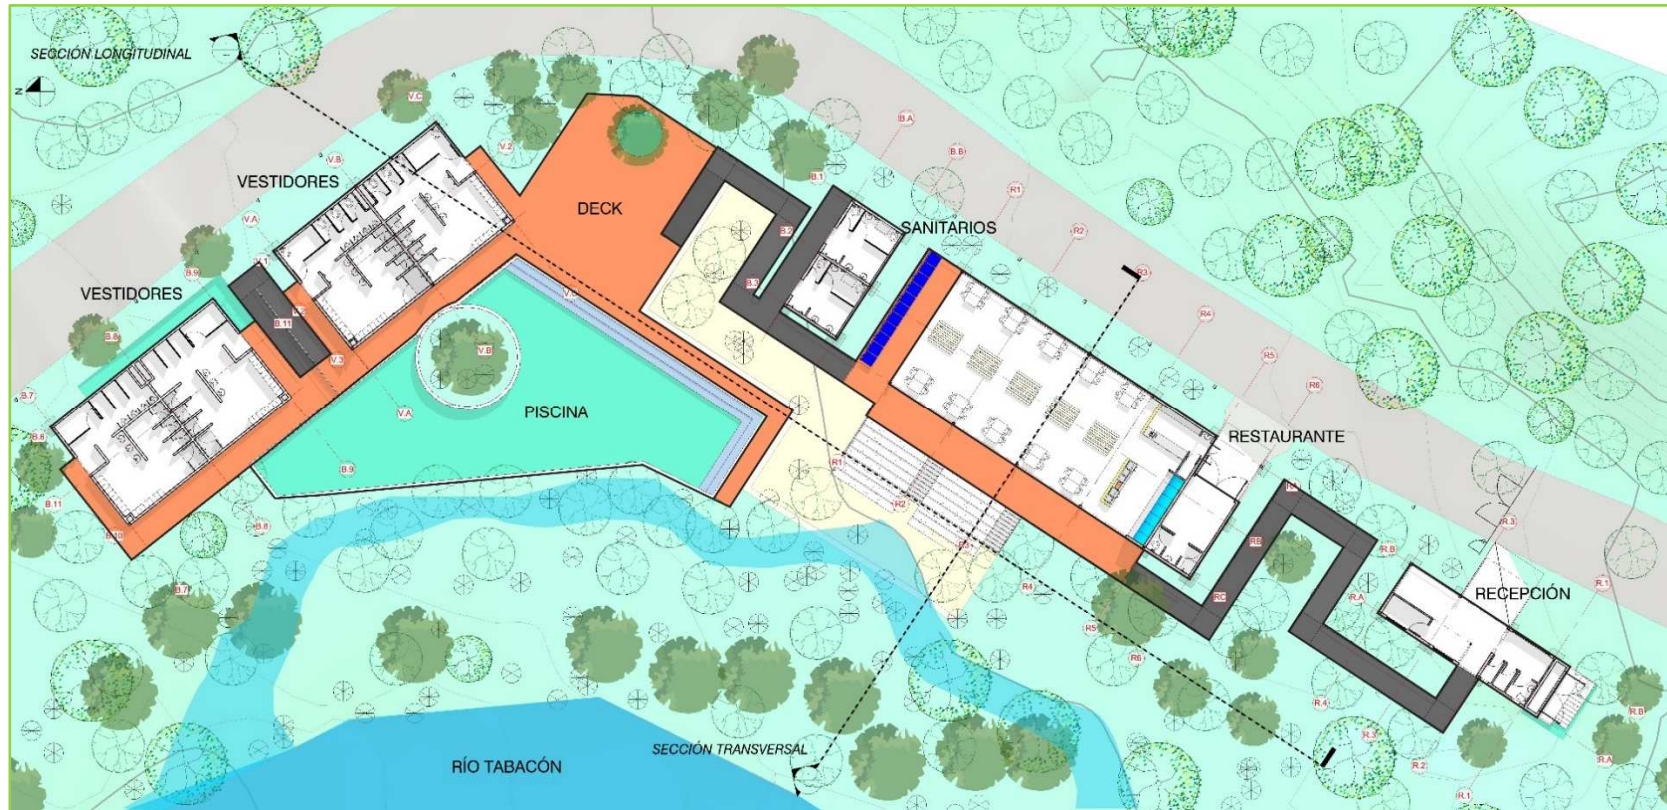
Planta del conjunto arquitectónico. Fuente: Elaborada por el autor.
